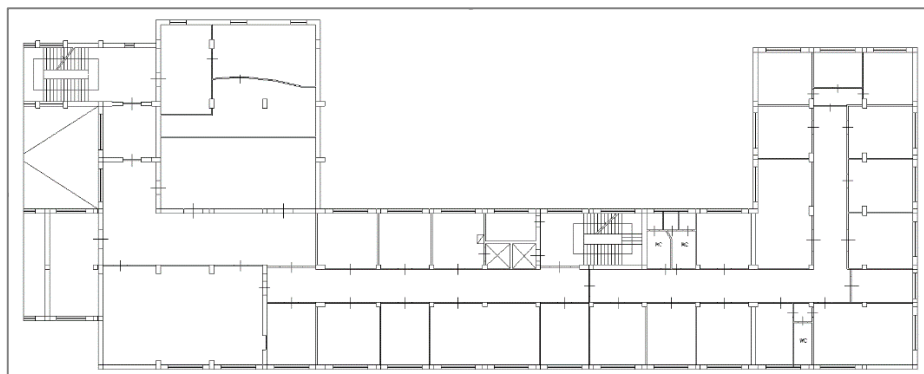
Planimetria tipica di edificio tipo ufficio.
